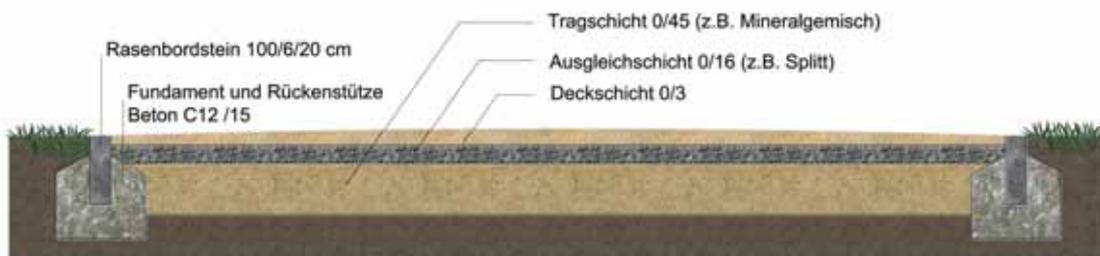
Aufbau Wassergebundene Wegedecke Uferpromenade
